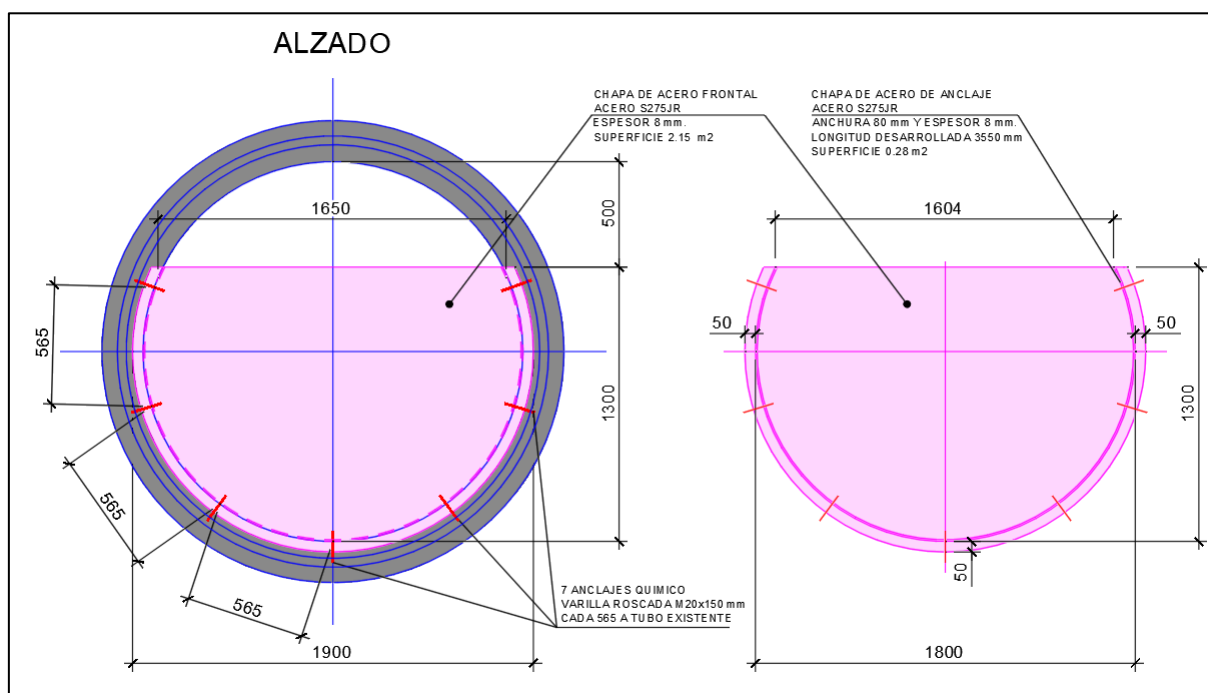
Alzado de la chapa de acero para la reducción de la sección de la conducción existente.
